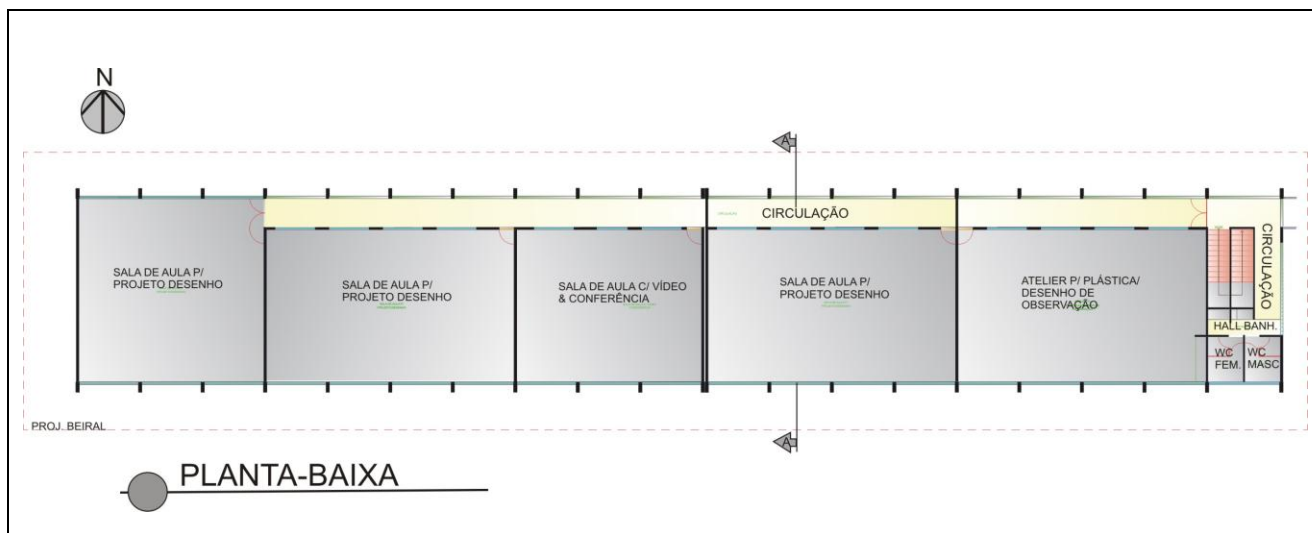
Planta baixa do bloco do Departamento de Transportes – pavimento superior
